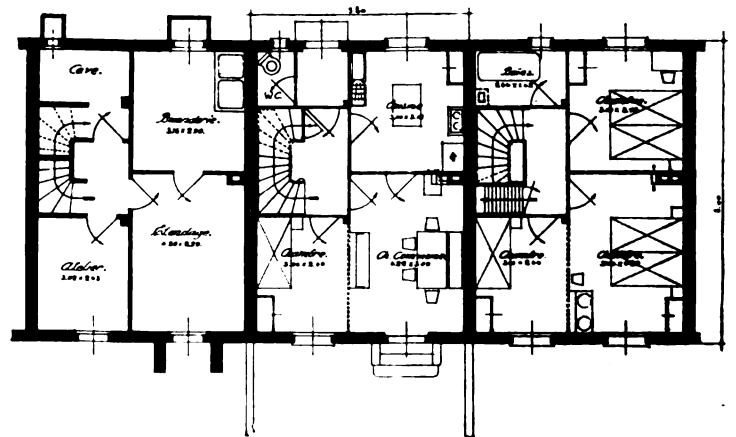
Einfamilien-Reihenhaus, Typ A. — Grundrisse 1 : 200.
